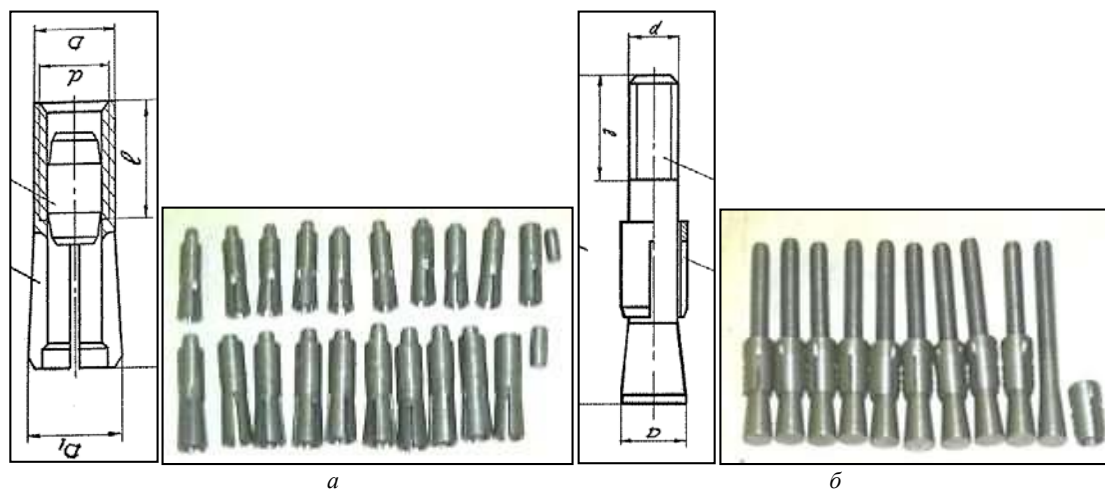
Конструкции распорных креплений: а – тип I; б – тип IV
